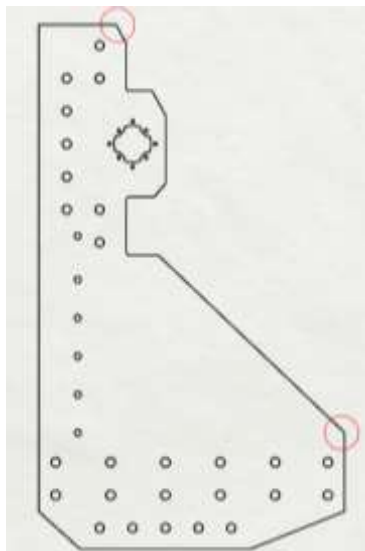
Пряме з'єднання верхньої частини стійки з нижньою
